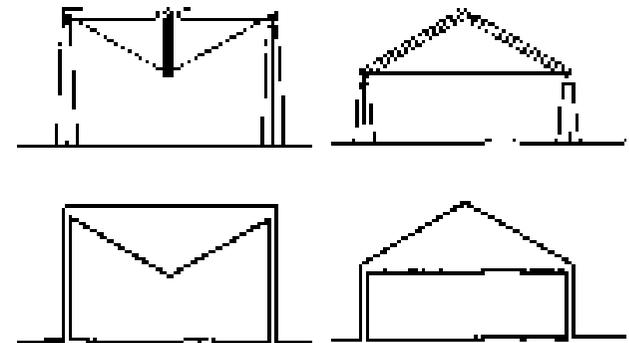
Vigas con tipos de apoyos. García, J. (2009) Construir como proyecto. Una introducción a la Materialidad Arquitectónica. Buenos Aires. Edi. Nobuko. Redibujado de autoría propia
